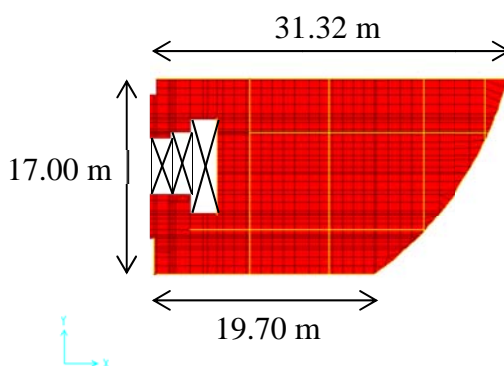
Dimensiones de la Planta Cielo Piso Décimo Tercer (S/E).
